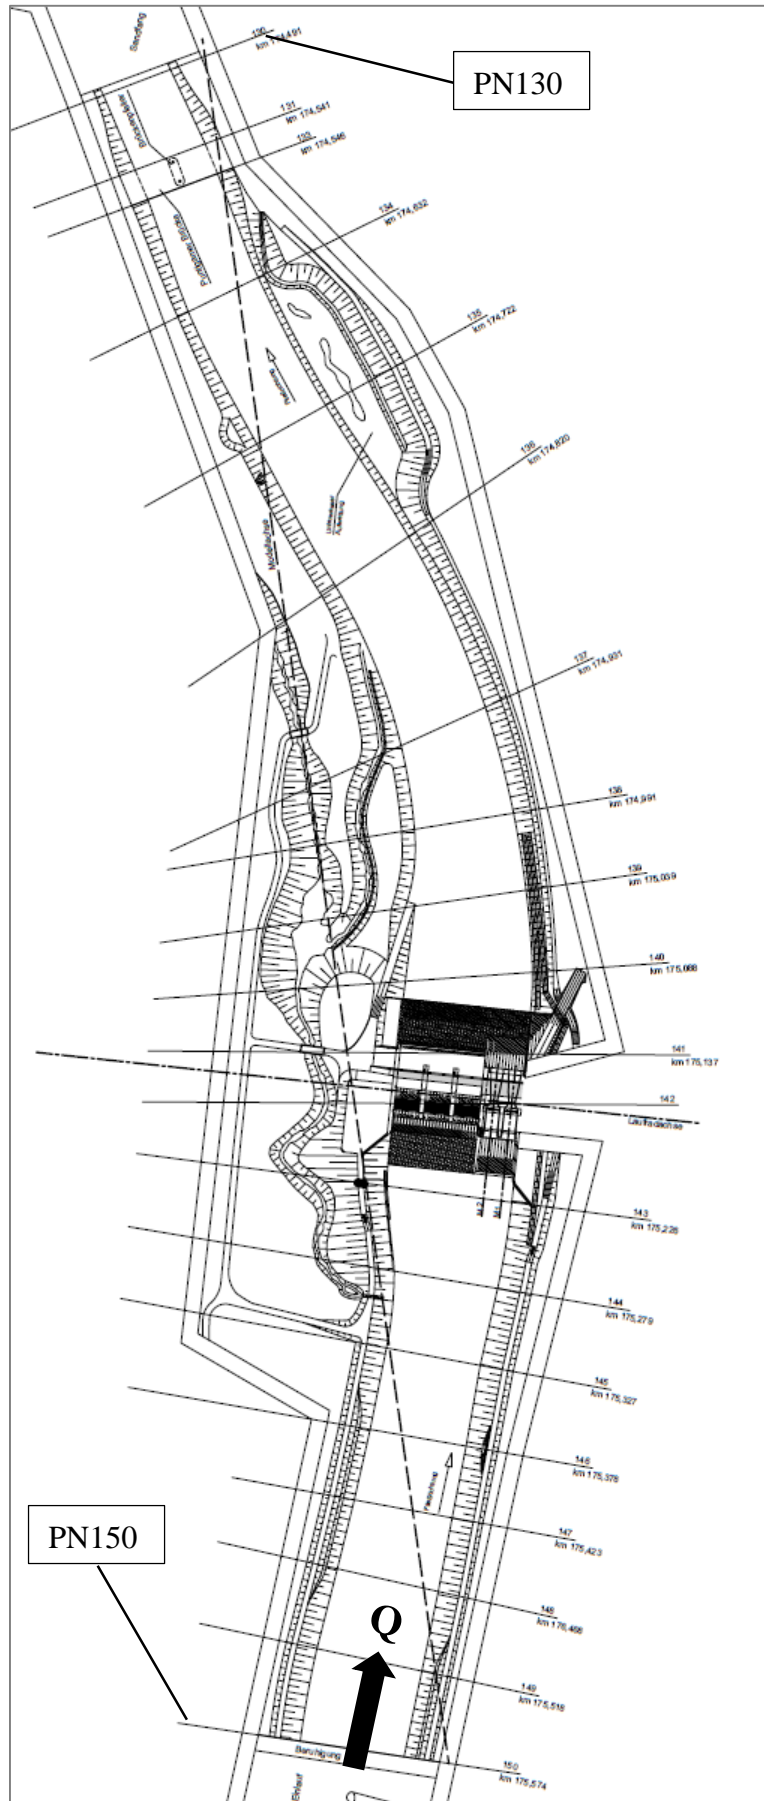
Grundriss Modellversuch (Quelle: Institut für Wasserbau und Wasserwirtschaft, TU-Graz)
